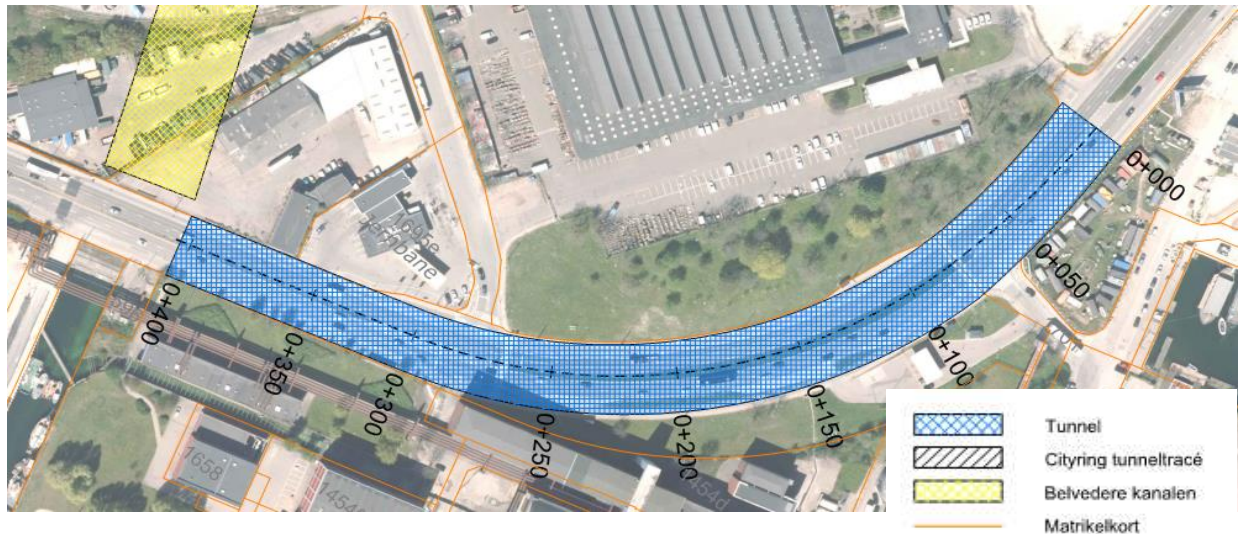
Overdækket tunnelloøsning, plantegning med markering af Belvedere kanalen.
